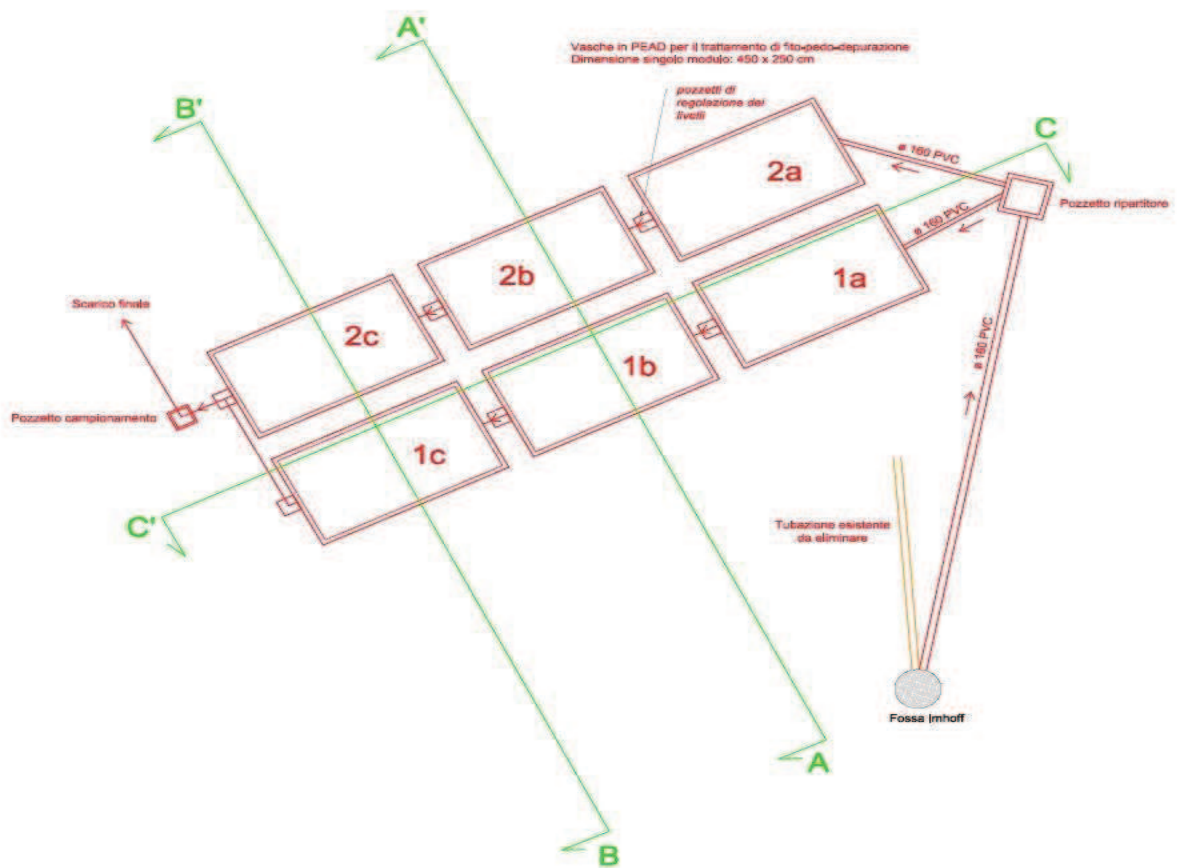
Planimetria dell'impianto in scala 1:100; (fonte: Parco dell'Adamello)
